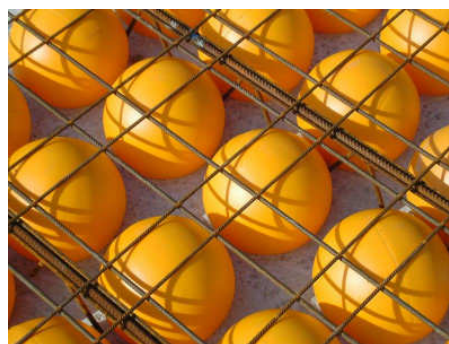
U-Boot Beton – rozmístění tvarovek zdroj [10]
